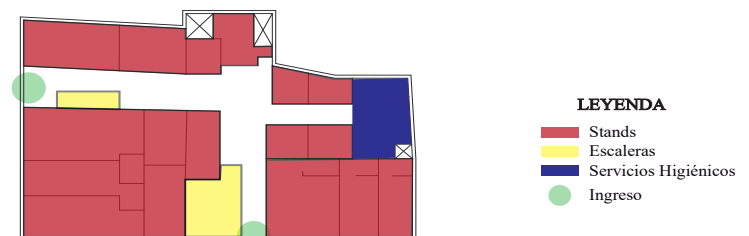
Plano de distribución de la galería Jesús Nazareno, analizada en Mesa Redonda.
